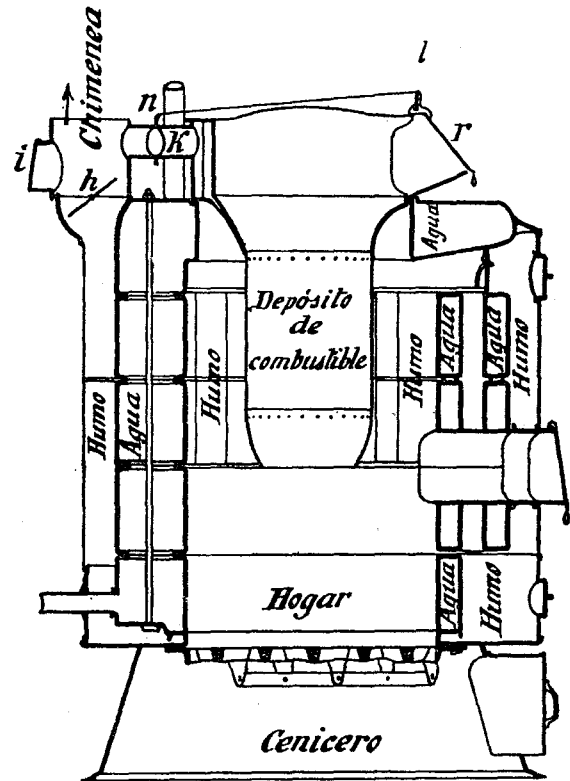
Caldera Hamelle de elementos de hierro colado, para la calefacción por vapor a baja presión.
